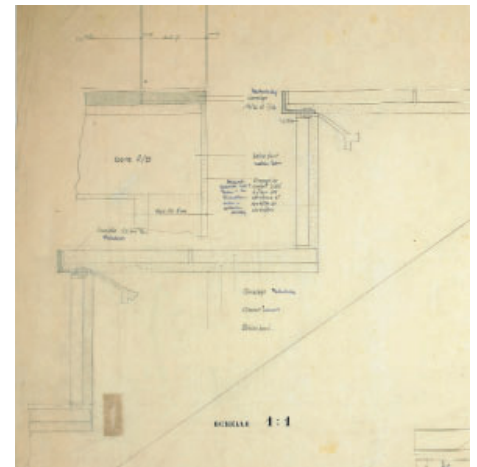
Detalle constructivo de los escalones de la Vivienda en Stuttgart, a escala 1:1, Atelier LC-PJ. FLC 07663 (pormenor).
